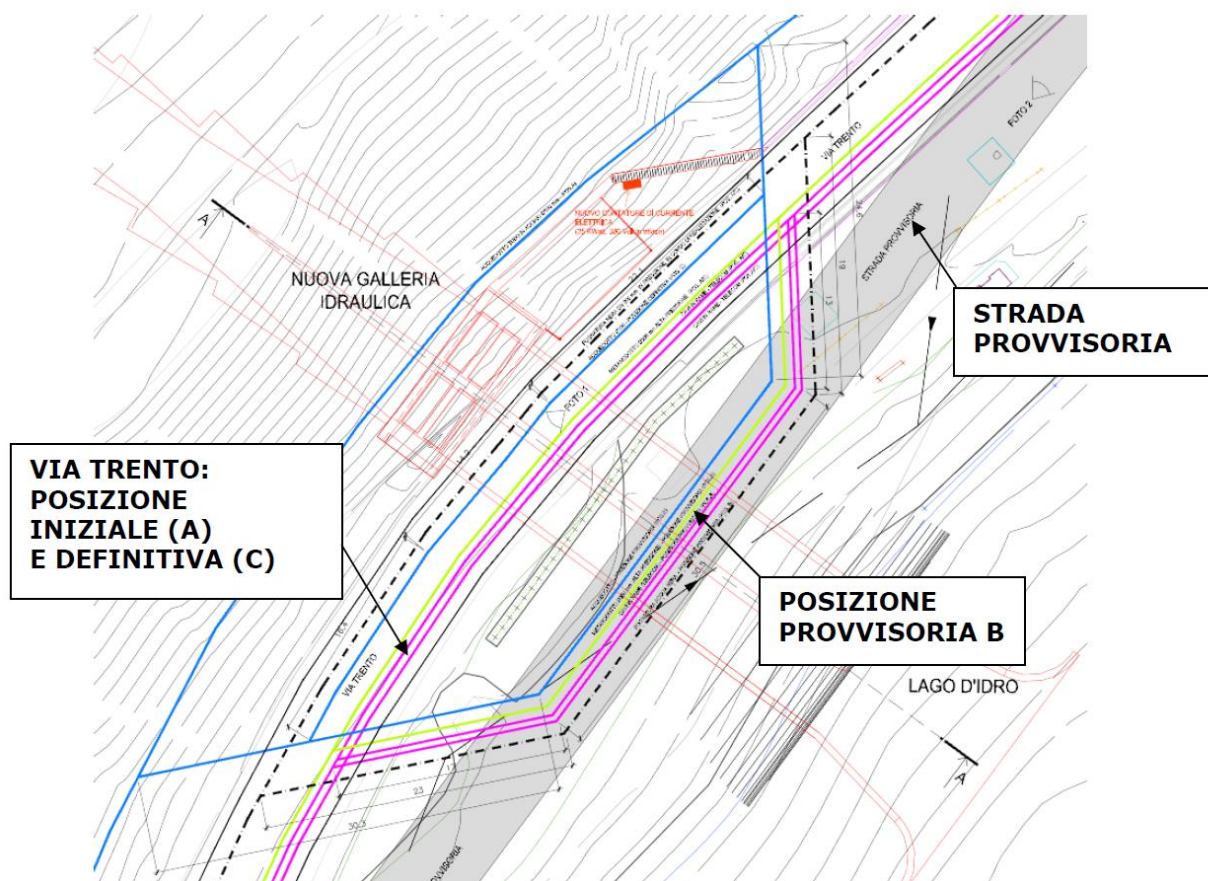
Planimetria con indicato lo spostamento dei sottoservizi in fase provvisoria dalla posizione (A) alla posizione (B), e in fase definitiva dalla posizione (B) alla posizione (C).
